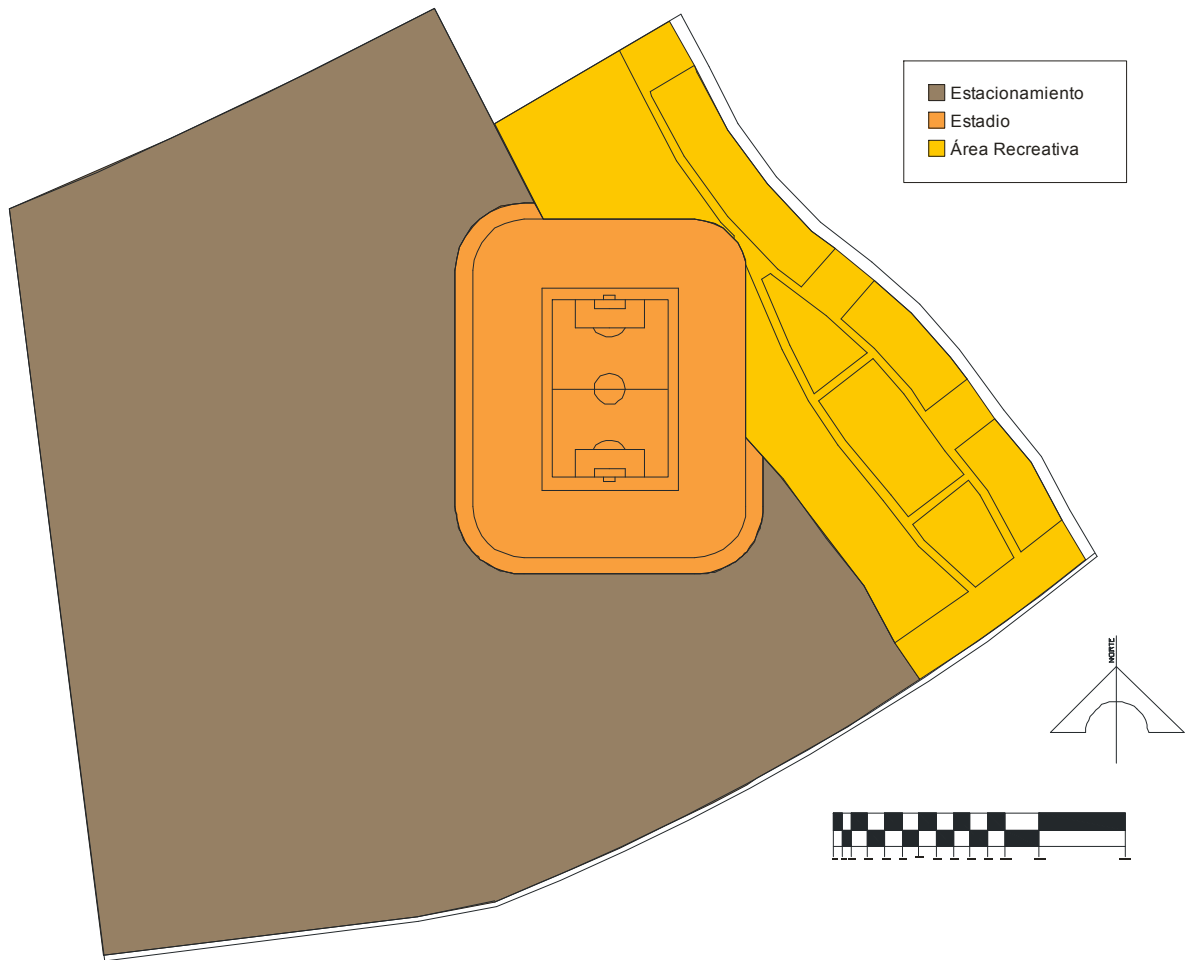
Dibujo que muestra la idea general del plan maestro
